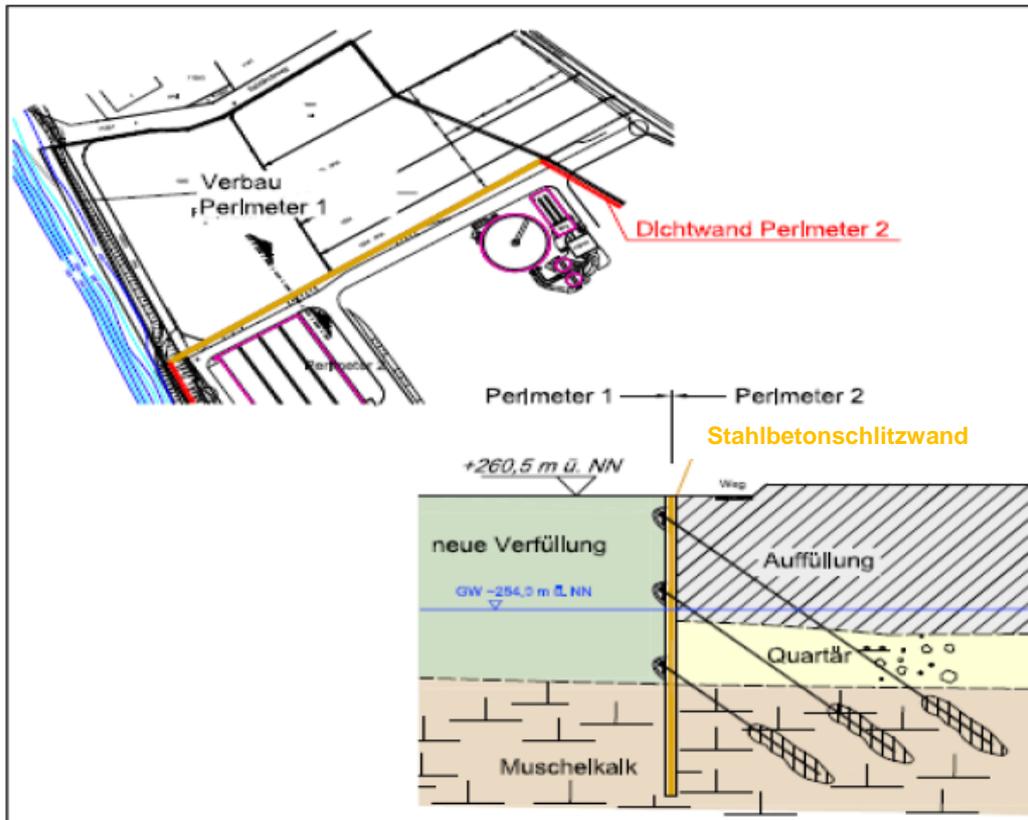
Aufsicht und schematischer Schnitt der Stahlbetonschlitzwand
